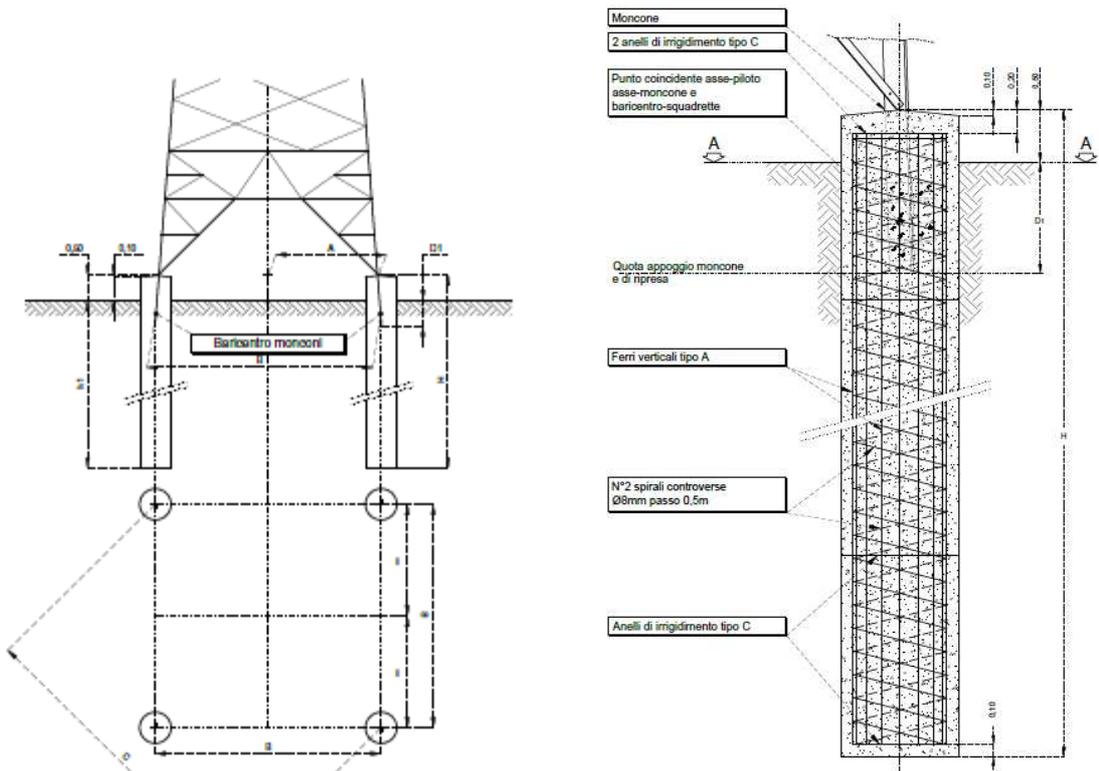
planimetria di dettaglio posizionamento sostegni.
